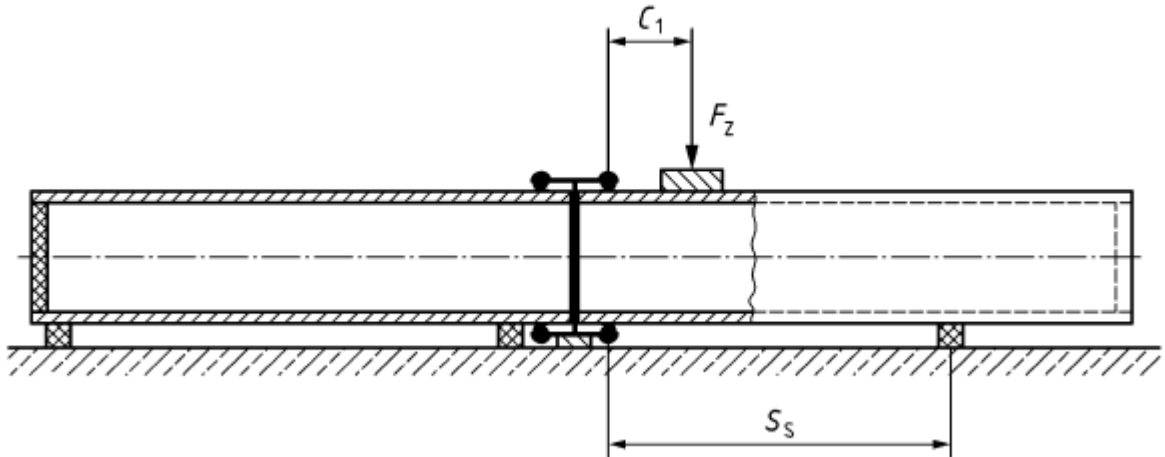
Essai sous cisaillement avec manchon sur point d'appui fixe
